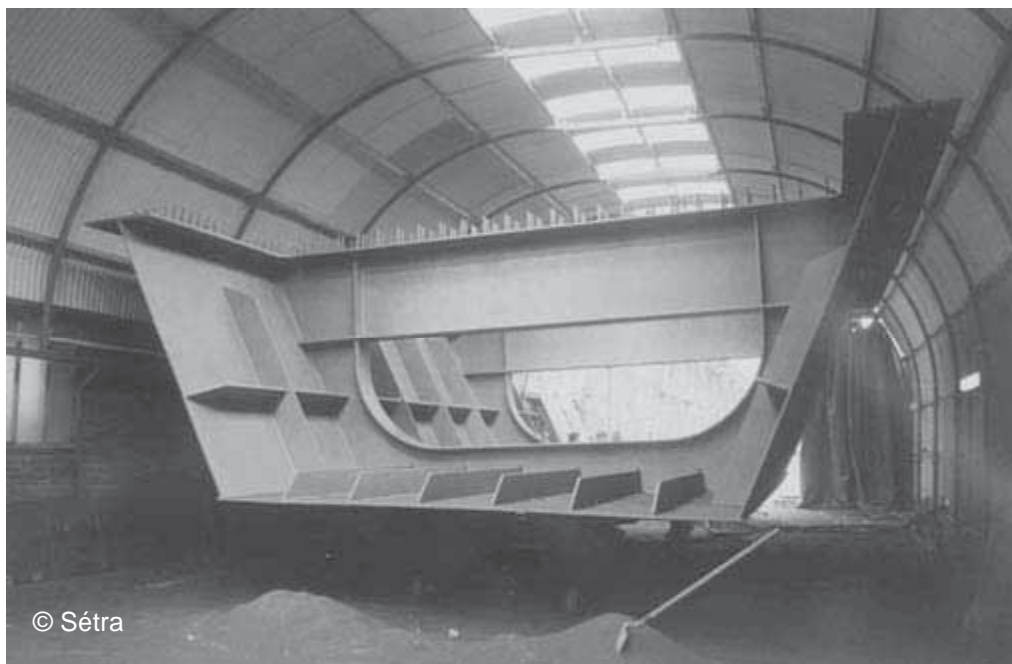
Poutre caisson à Lille, France (raidisseurs à section ouverte).
